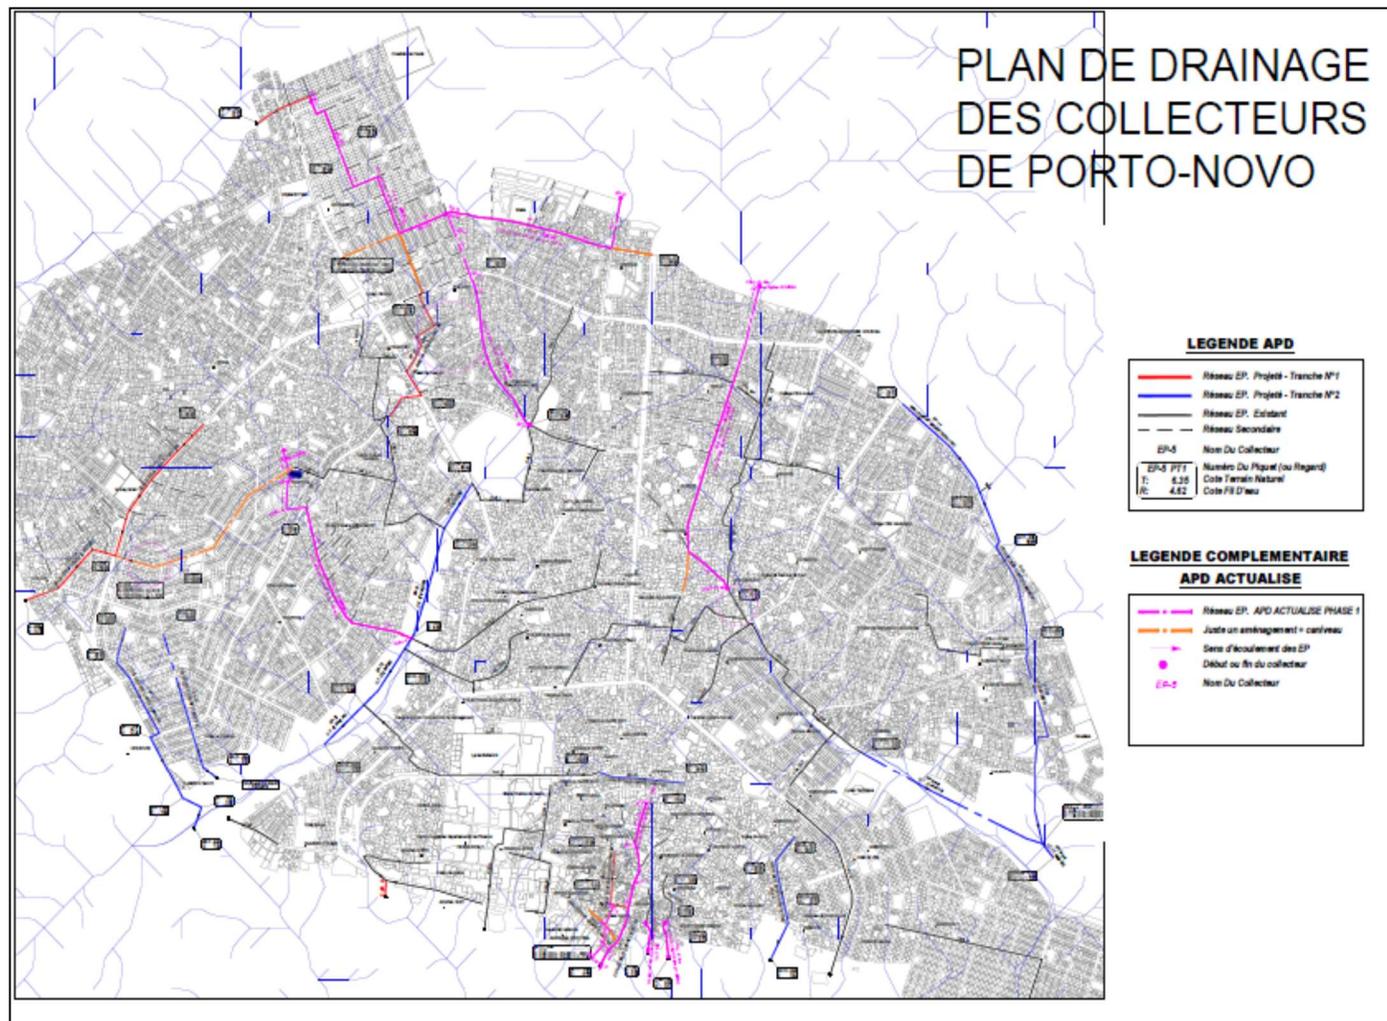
Plan de drainage des collecteurs de Porto-Novo
